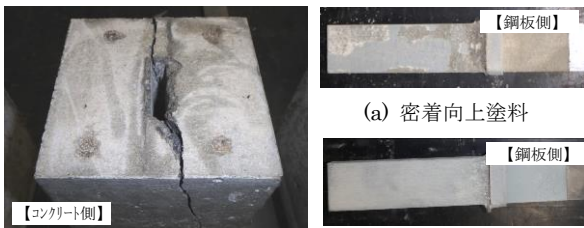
引抜き試験後の割裂ひび割れ状況
